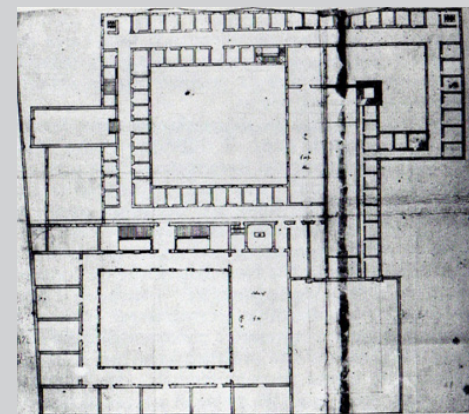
"Progetto di sistemazione del primo piano del palazzo Braidense con biblioteca", 1675/80. Milano, Biblioteca Trivulziana, Raccolta Bianconi
